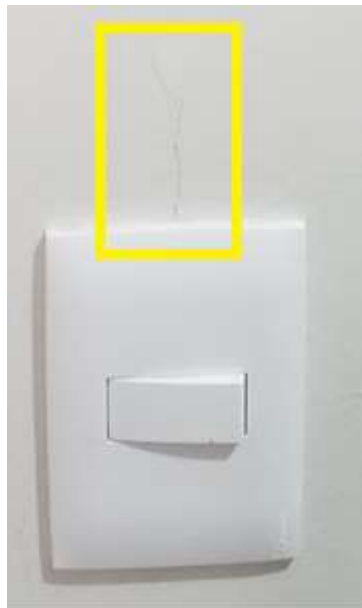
Fisura provocada en muros por instalaciones eléctricas
